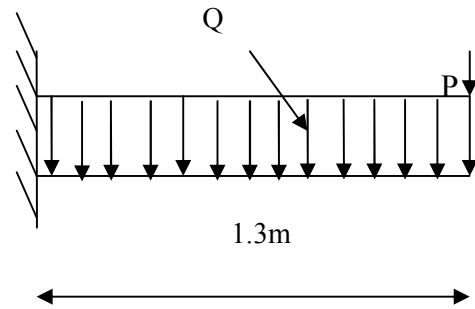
Schéma statique de la dalle sur un seul appui.
